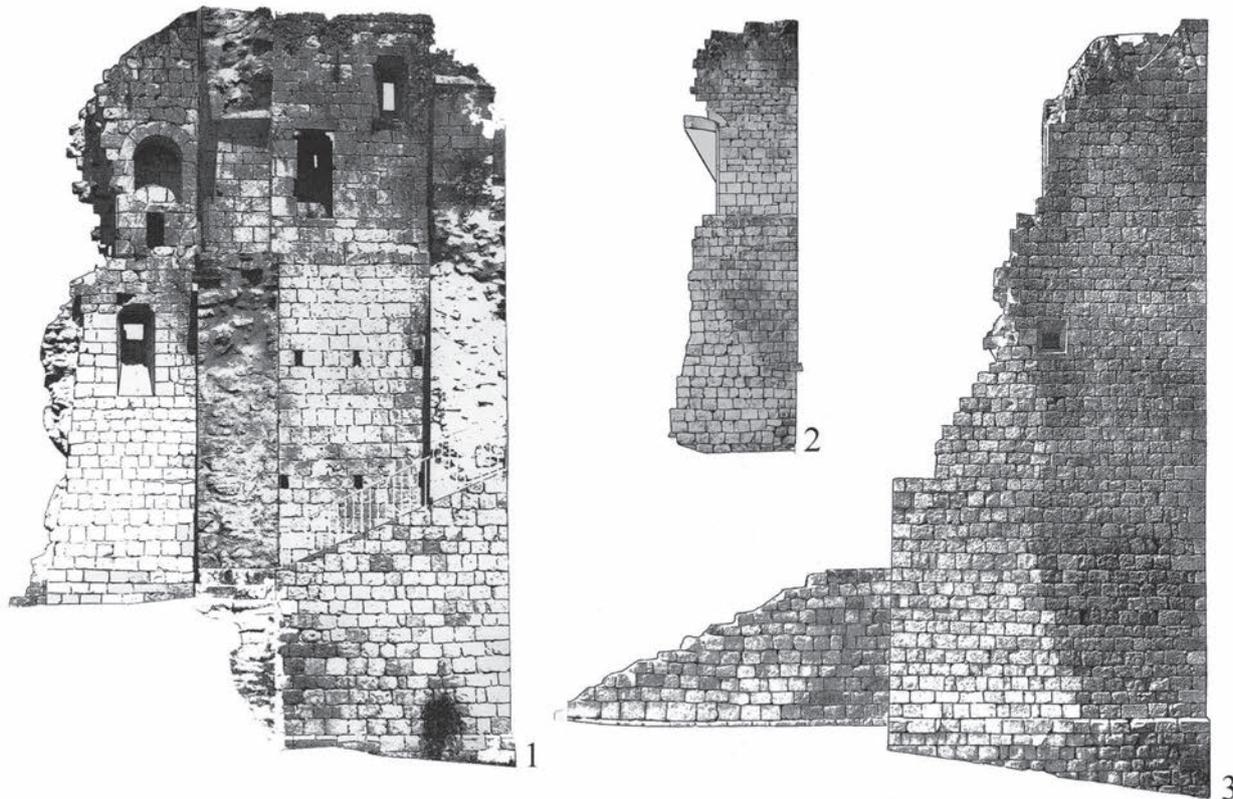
DUNES. SITE DU « TURAS ». Relevés photogrammétriques et pierre à pierre. Face nord, parement interne (n° 1) ; face ouest (n° 2) et face est, parement externe (n° 3). *Relevés Ch. Darles.
